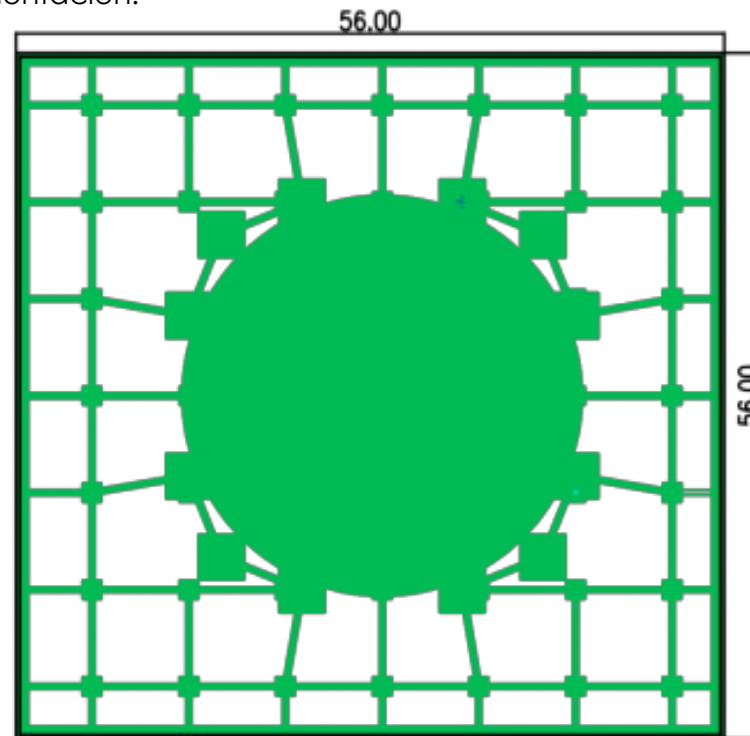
Distribución aproximada de la cimentación con zapatas
